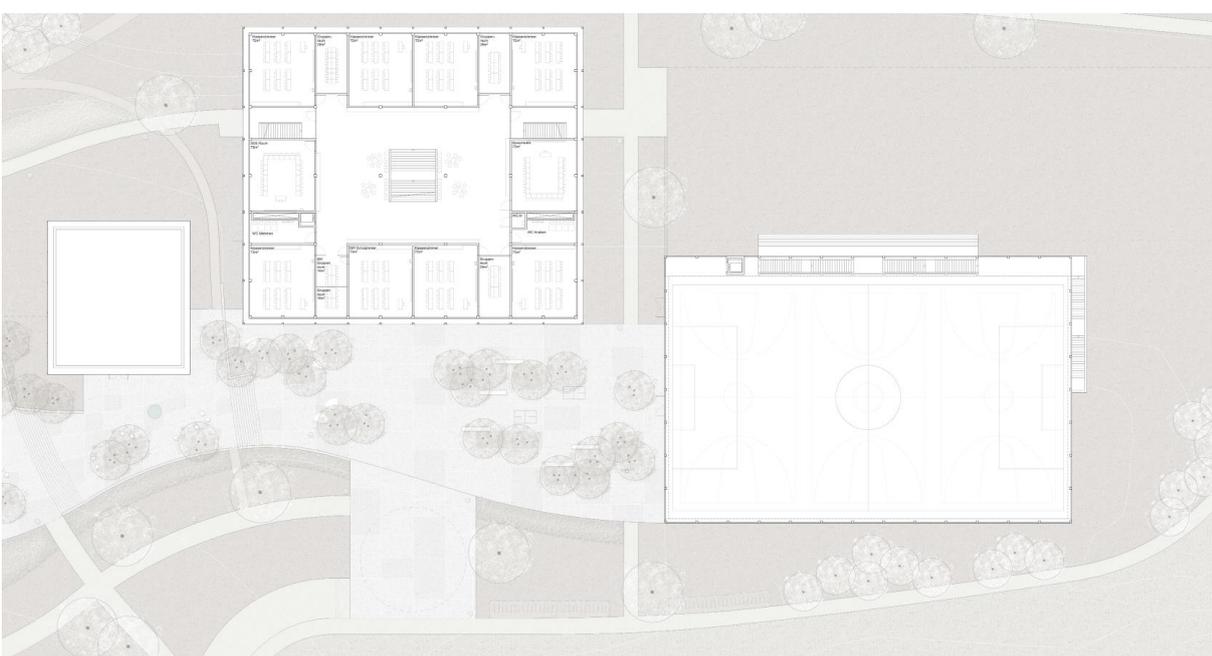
Grundriss 1. Obergeschoss Singsaal, Sekundarstufe und Doppelsporthalle
